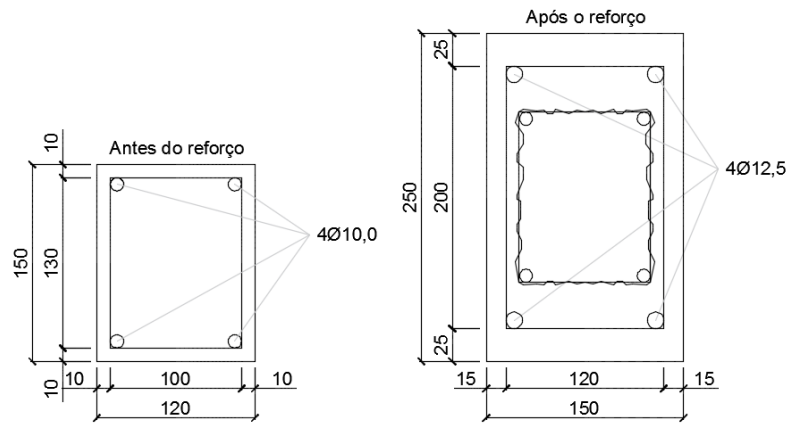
Sección transversal de los pilares antes y después del refuerzo.
